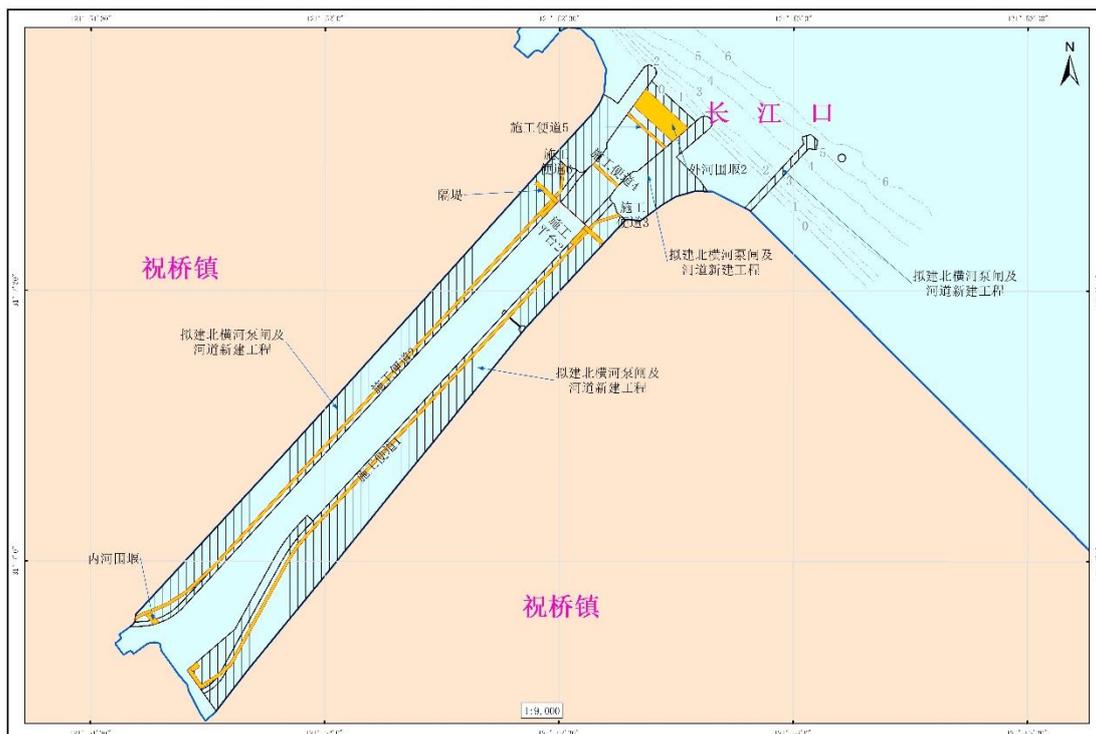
施工配合设施与主体工程权属范围重叠示意图
